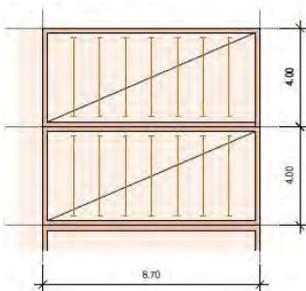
Konstruktionsdarstellung, Treet, Bergen
